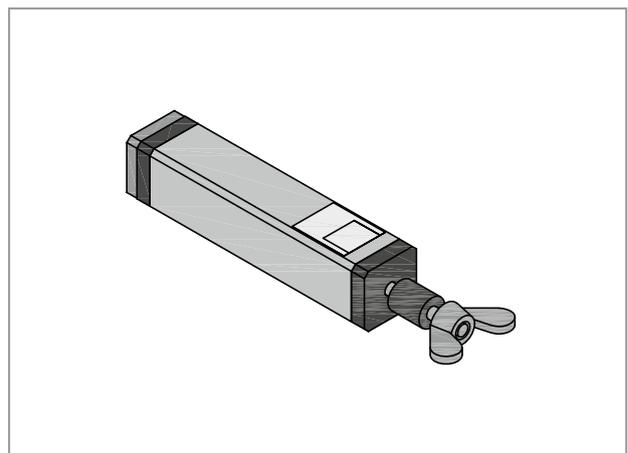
Schöck Tronsole® Typ P: Montageelement
